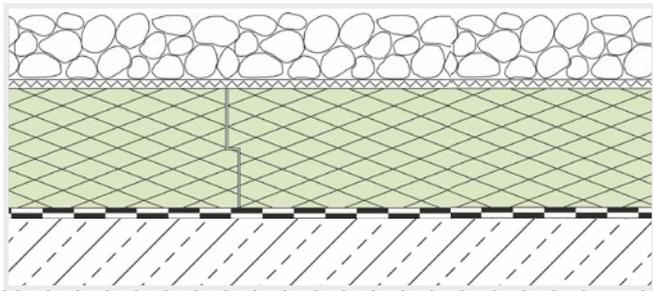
Ausführung einlagig bekiestes Umkehrdach.
